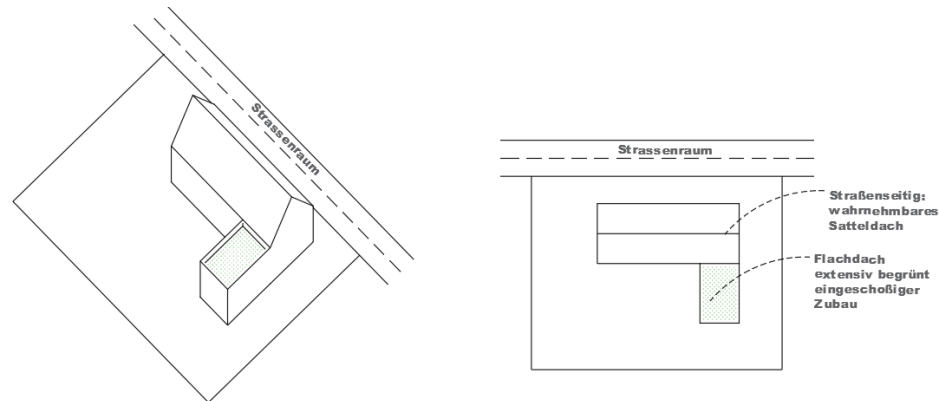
Zulässigkeit von untergeordneten Baukörpern mit Flachdachausführung
